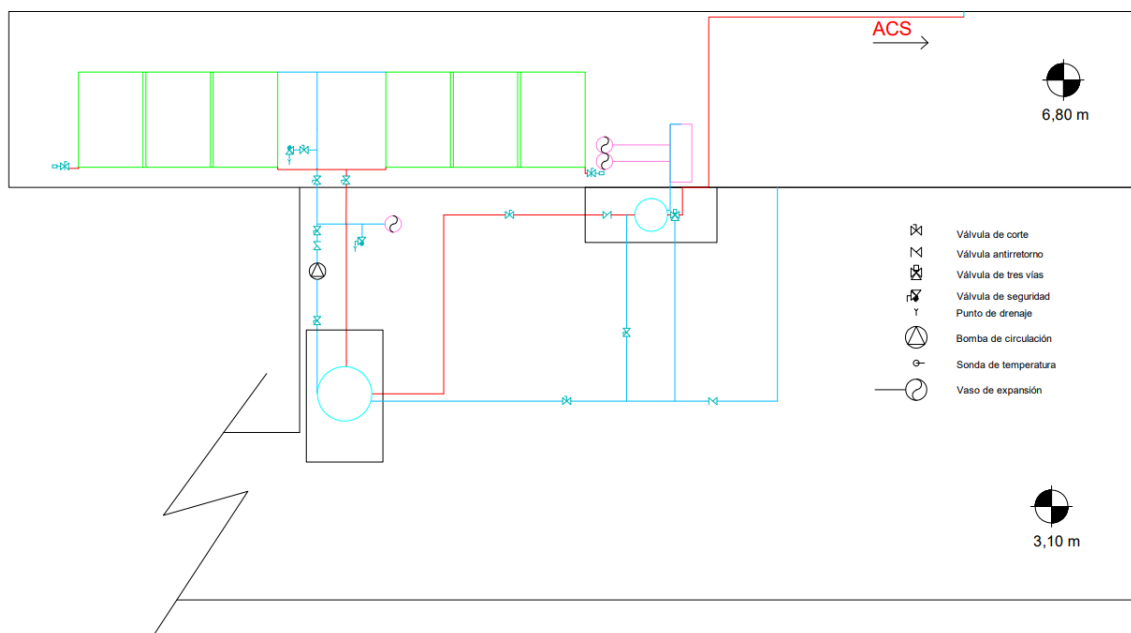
Vista en planta del circuito hidráulico de la instalación.
